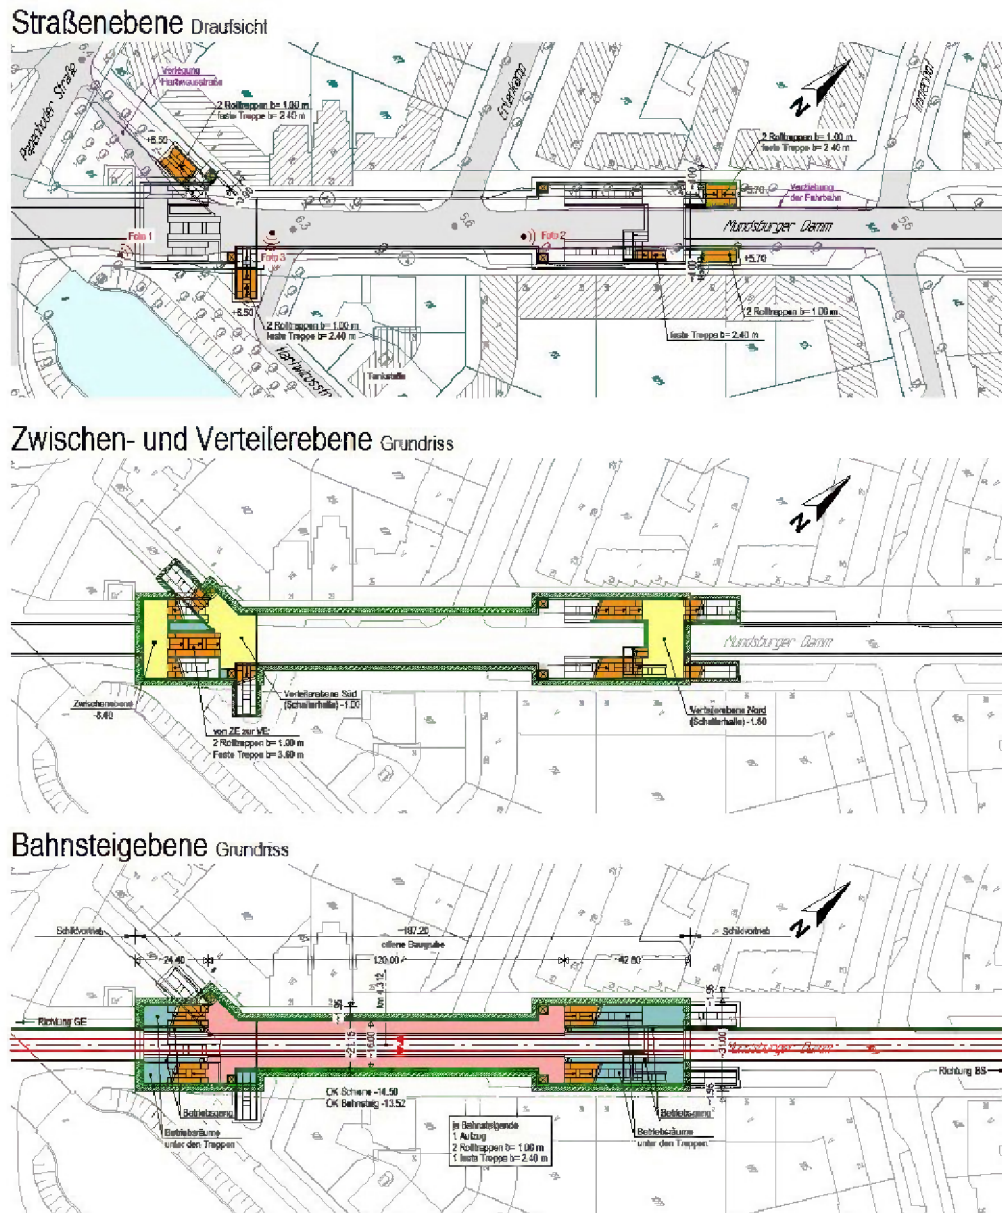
Lageplan Haltestelle Uhlenhorst I
